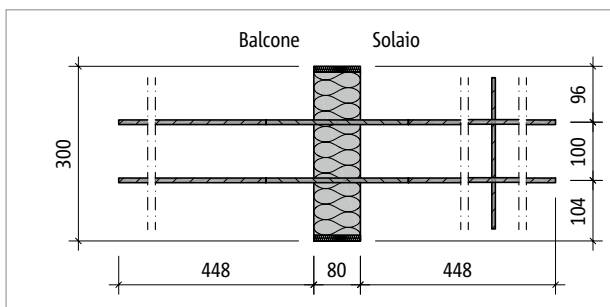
Schöck Isokorb® T tipo QP-Z-V1: pianta del prodotto
